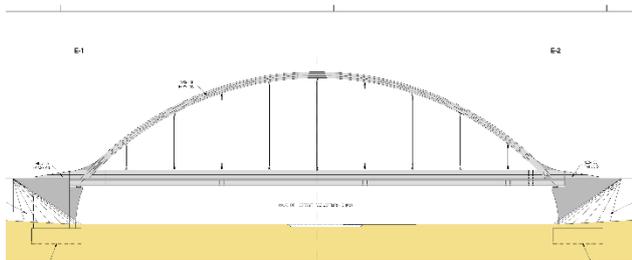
Alzado del puente sobre el gajo del Arroyo Tacuarembó.
